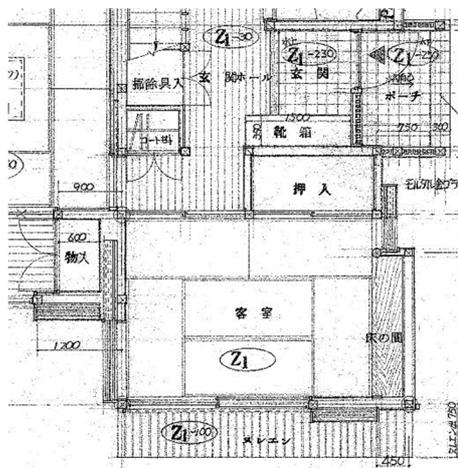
「小杉邸」(1976) 1階平面図(部分)
